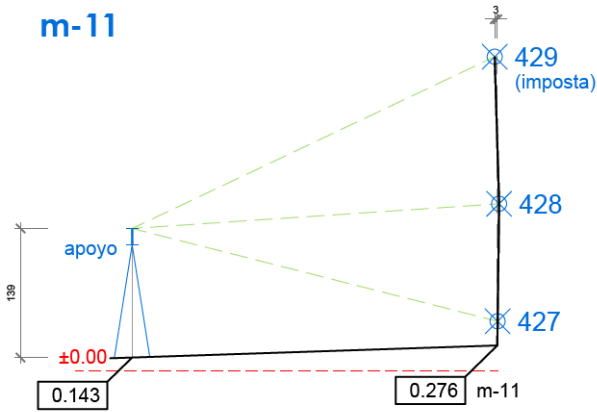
Levantamiento de muros del crucero Sur (elaboración propia).
